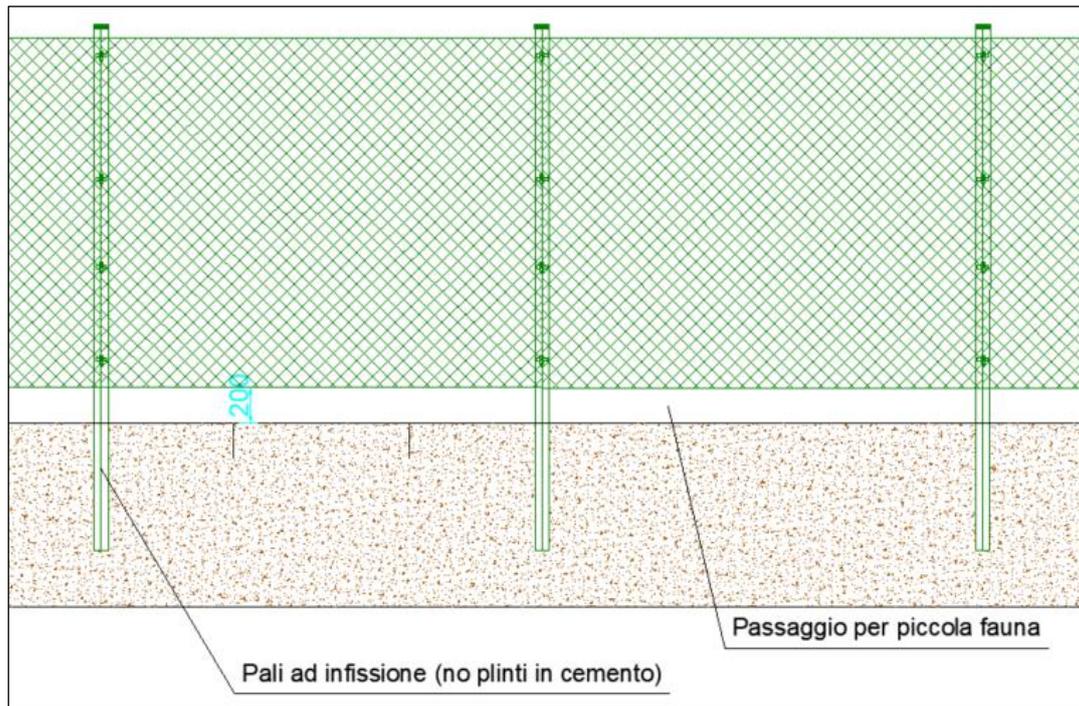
Dettaglio del sollevamento della recinzione perimetrale per permettere il passaggio della piccola fauna.
